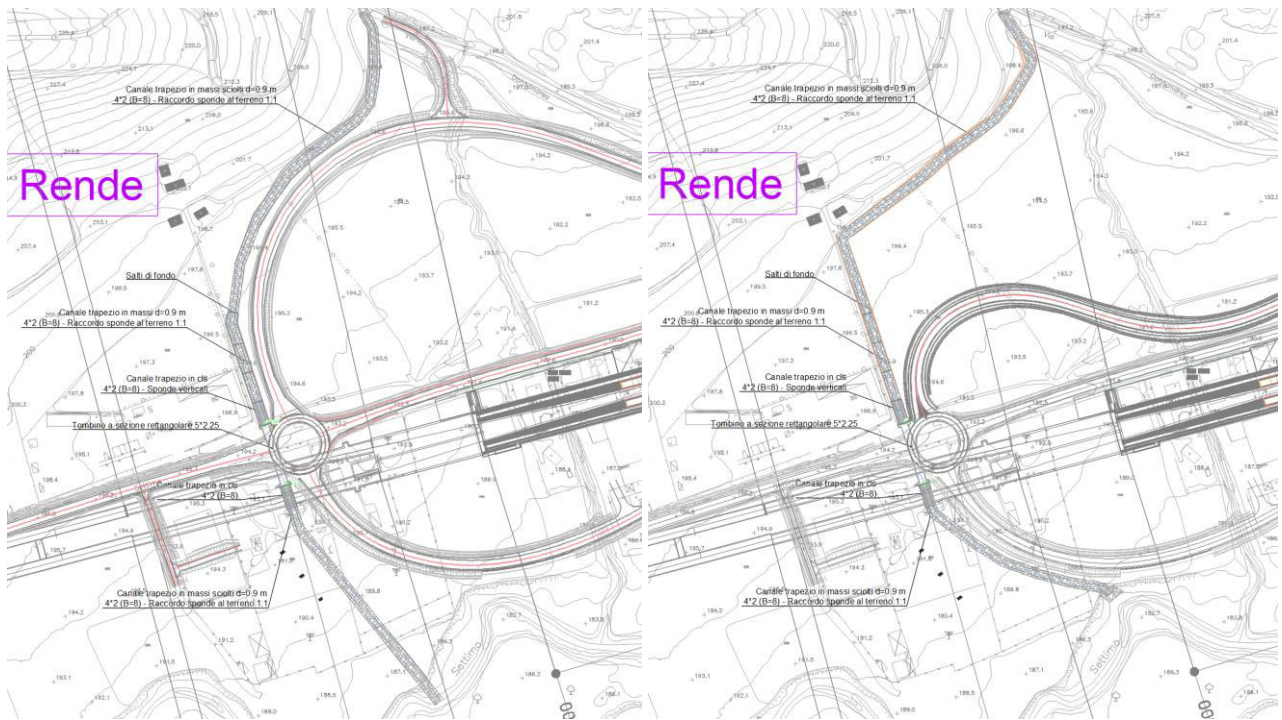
Stralcio planimetrico del canale in progetto: a sx la soluzione di Luglio 2022 mentre a dx quella di Marzo 2023
